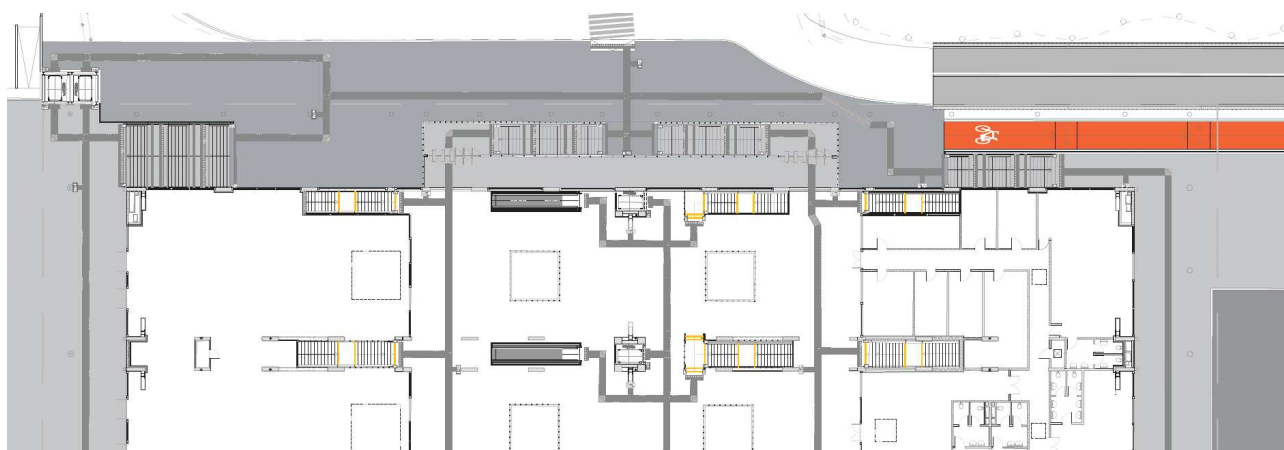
Planimetria di inquadramento del nuovo ingresso est.
